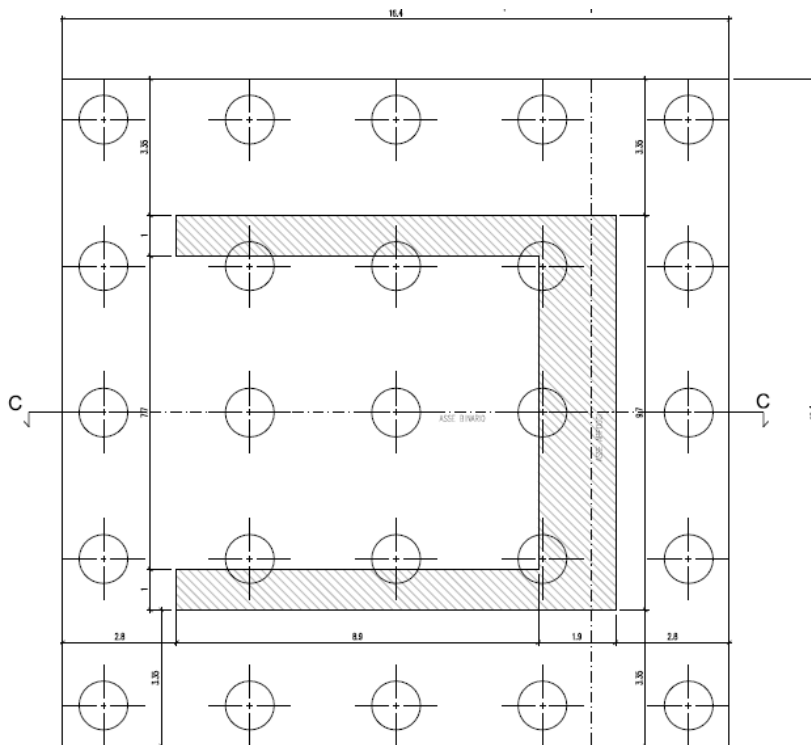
Pianta fondazioni "Spalla A"
